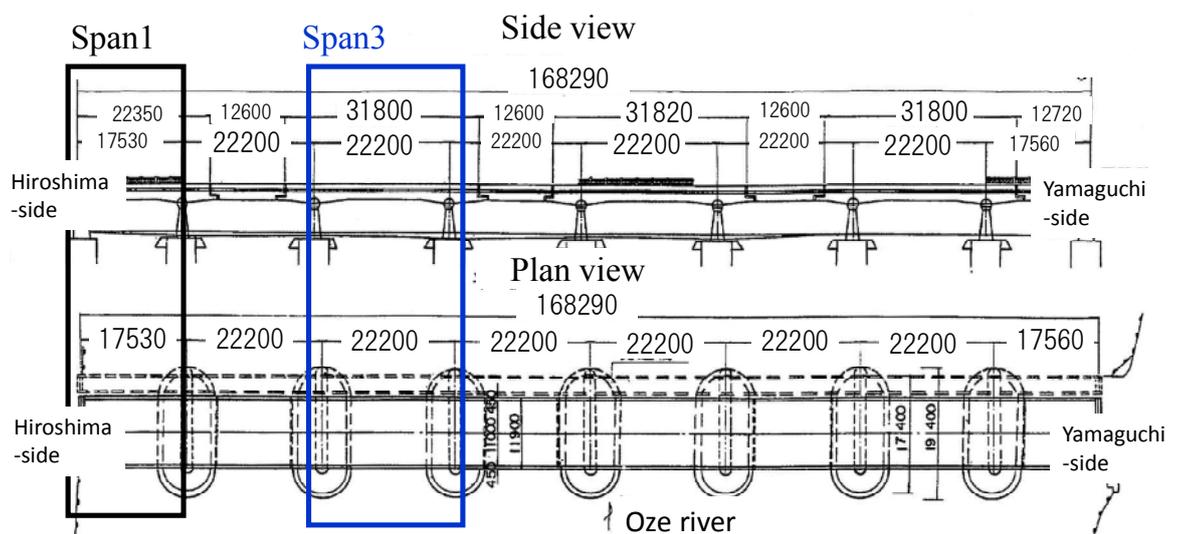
「栄橋」側面図および平面図(撤去前)と調査区間
